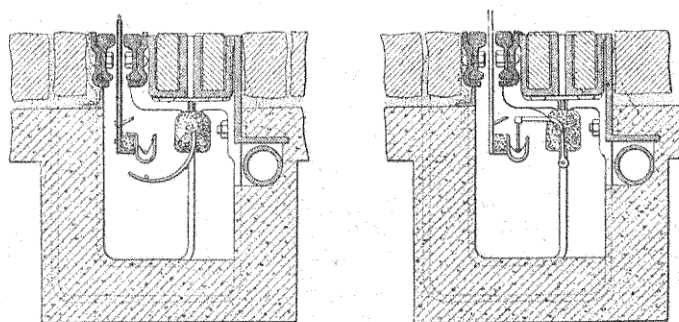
et 612. — Coupes du caniveau Waller-Manville.
